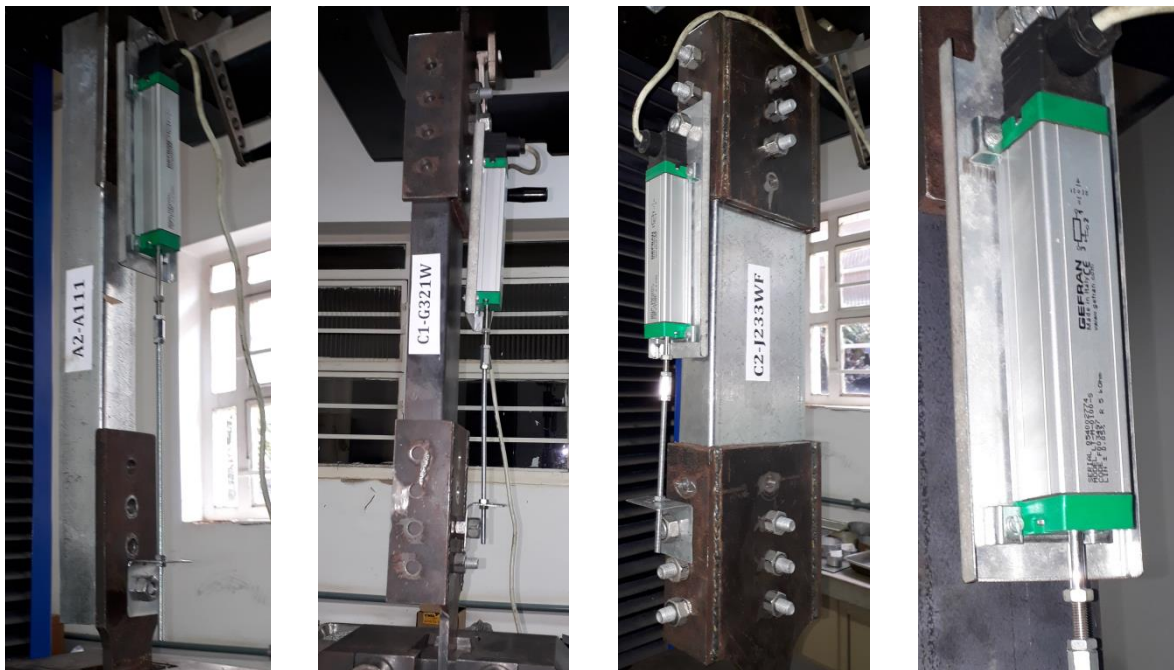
Detalhes do transdutor de deslocamento instalado nos parafusos das conexões.
